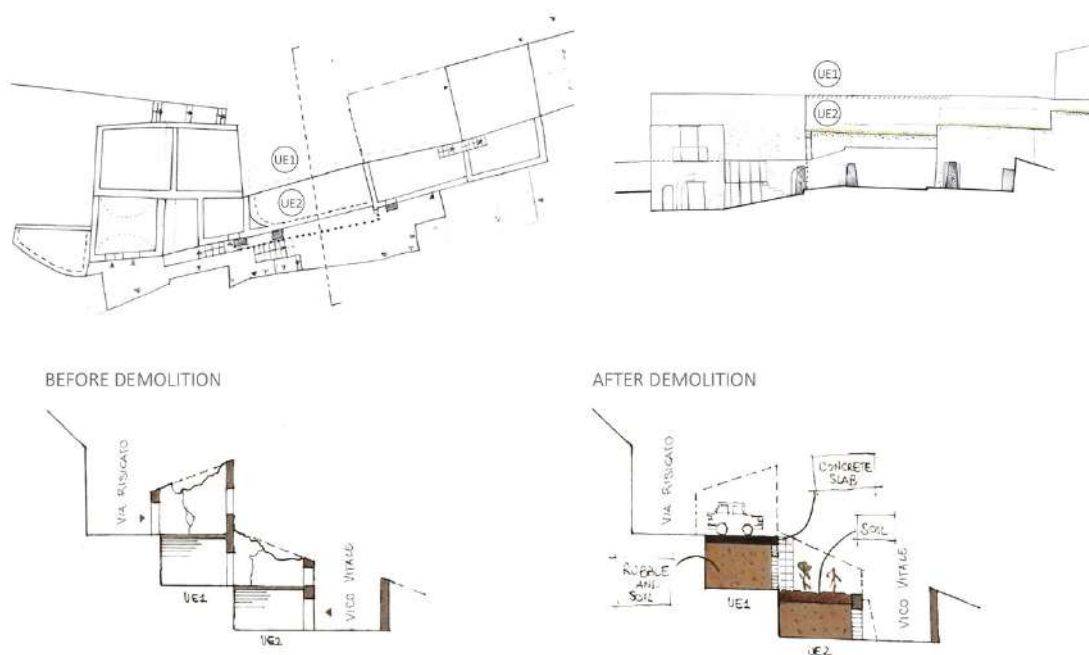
Ipotesi ricostruttiva dello stato prima delle demolizioni e dell'intervento di parziale demolizione e messa in sicurezza lungo tra Vico Vitale e via Riscato (da CIRCO et al. cds).
